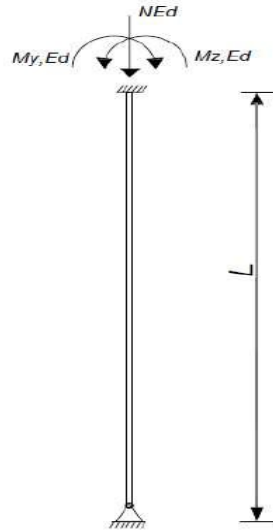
Schéma statique poteau mixte sous compression et flexion biaxiale
